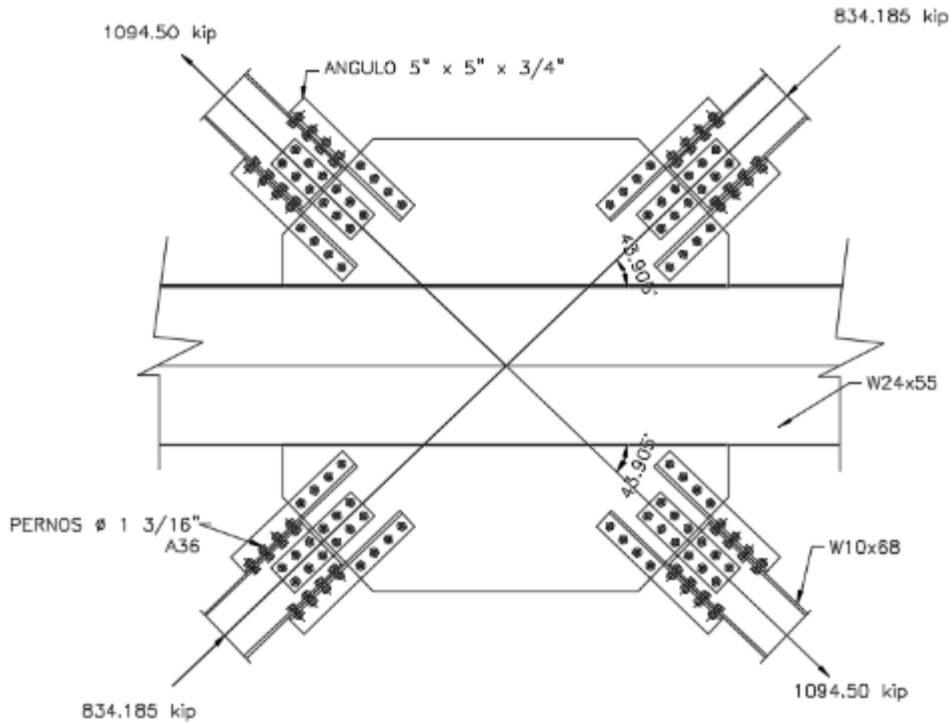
Conexión de arriostreros en centro de la viga. Fuente: Propia realizado en AUTOCAD.
